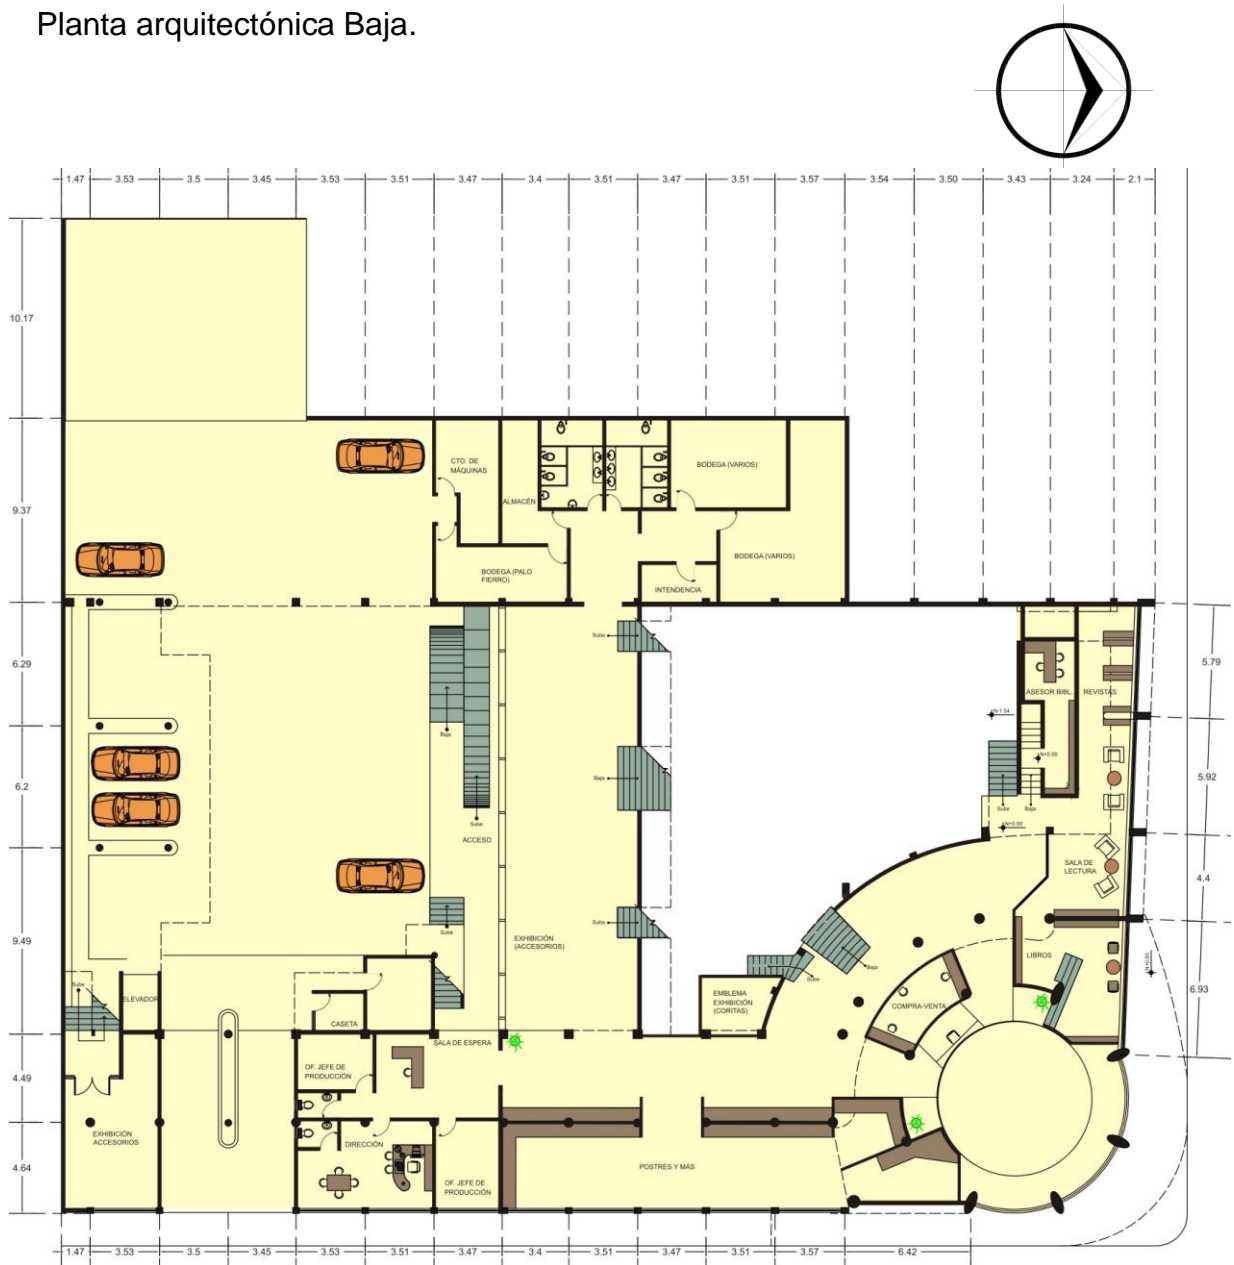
Partido arquitectónico planta baja. Fuente: Autoría propia. S/E.
